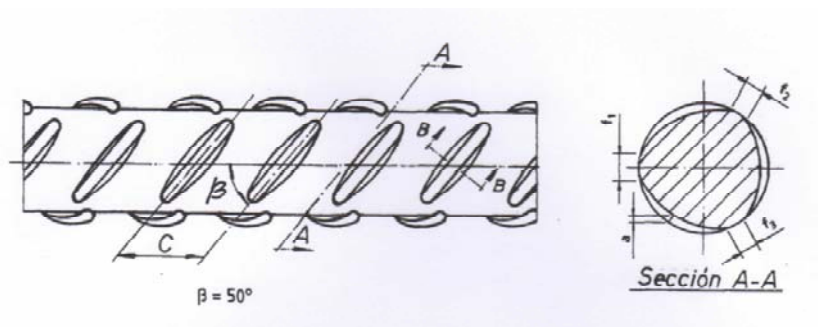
Geometría de los aceros inoxidables trefilados según UNE 36067:94
